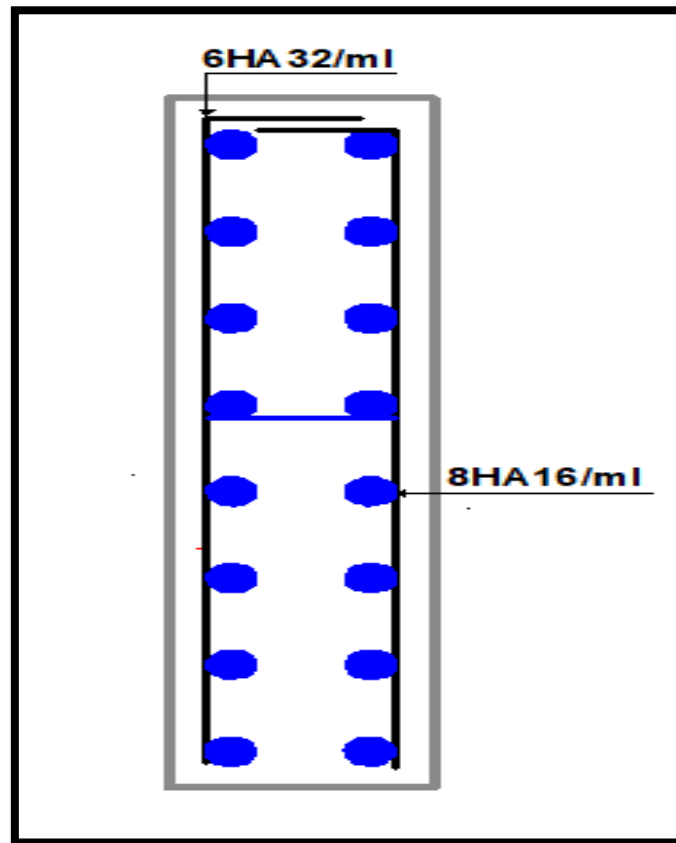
Vue en coupe longitudinale du ferrailage de la culée
